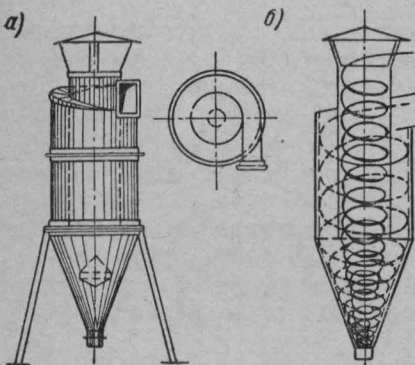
Циклоны: а) внешний вид; б) схема движения воздуха
